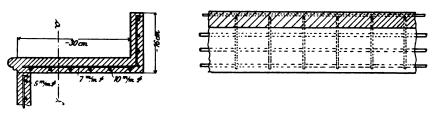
u. 93. Treppenstufen aus Eisenbeton.
